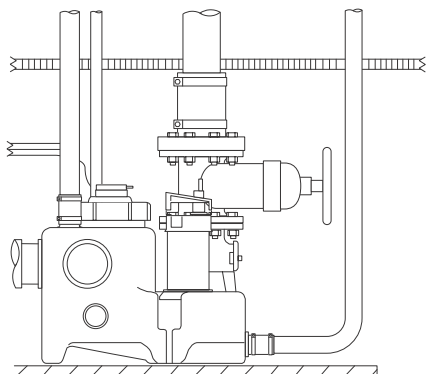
Ізоляційний клапан на вершині зворотного клапану
